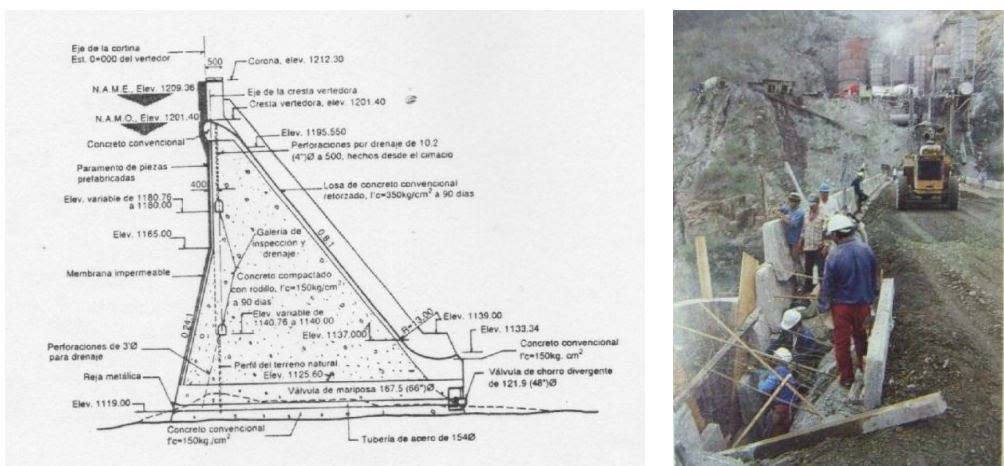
SECCION Y COLOCACION DE FORMAS PREFABRICADAS
